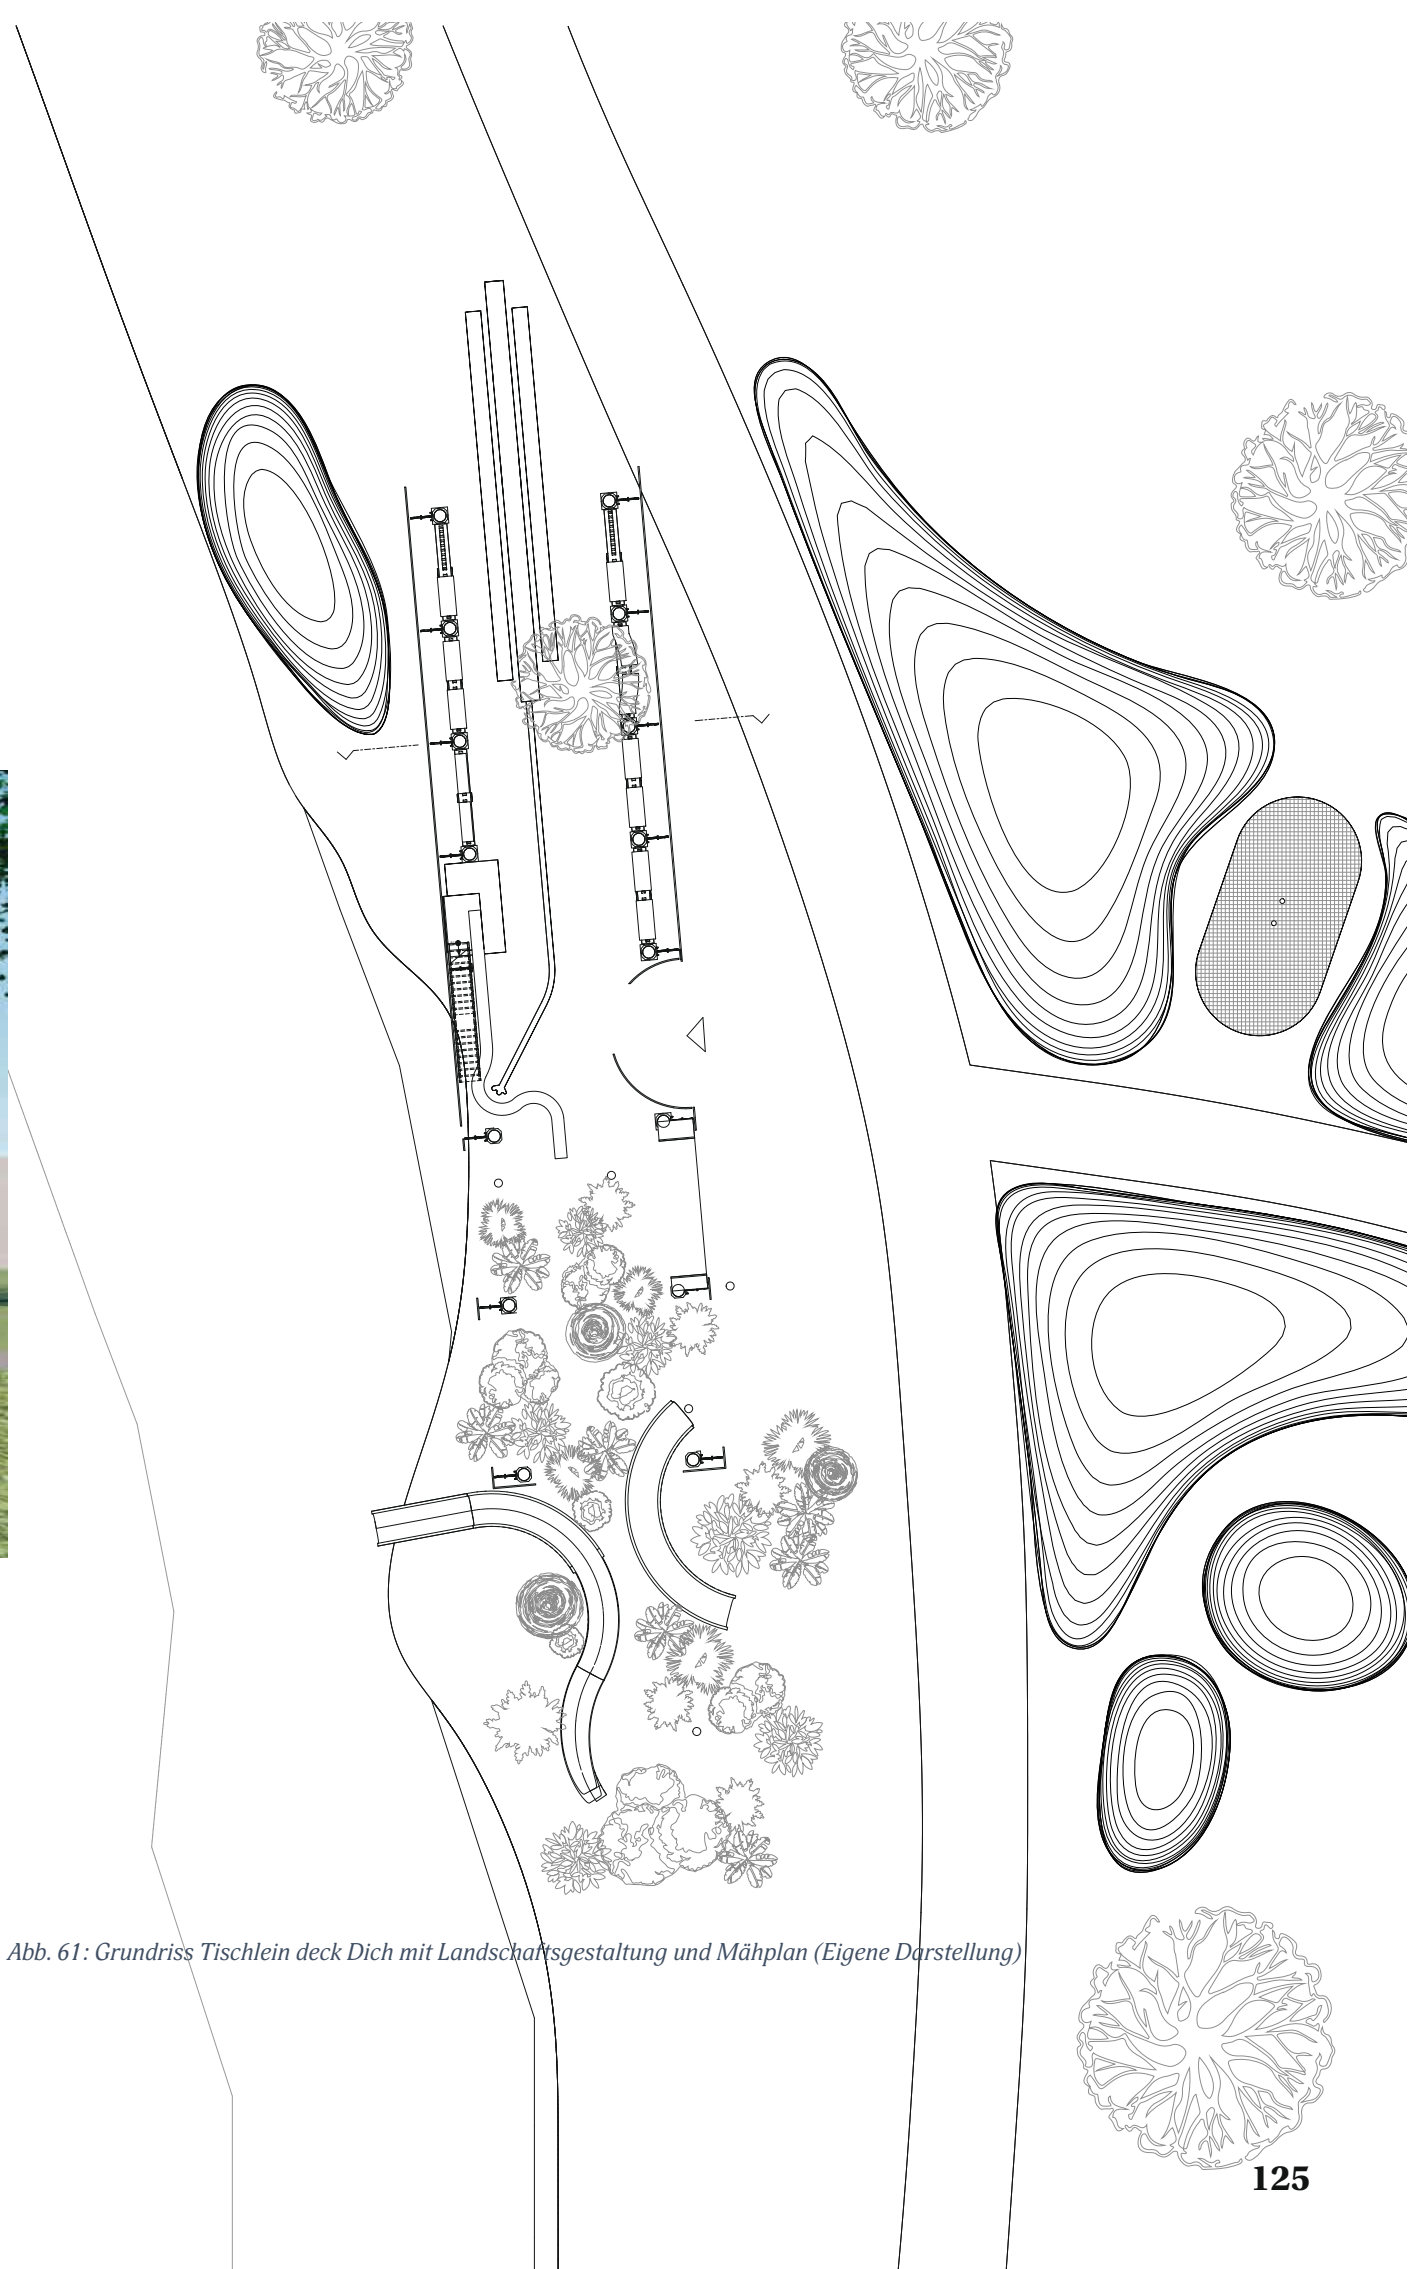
Grundriss Tischlein deck Dich mit Landschaftsgestaltung und Mähplan (Eigene Darstellung)
